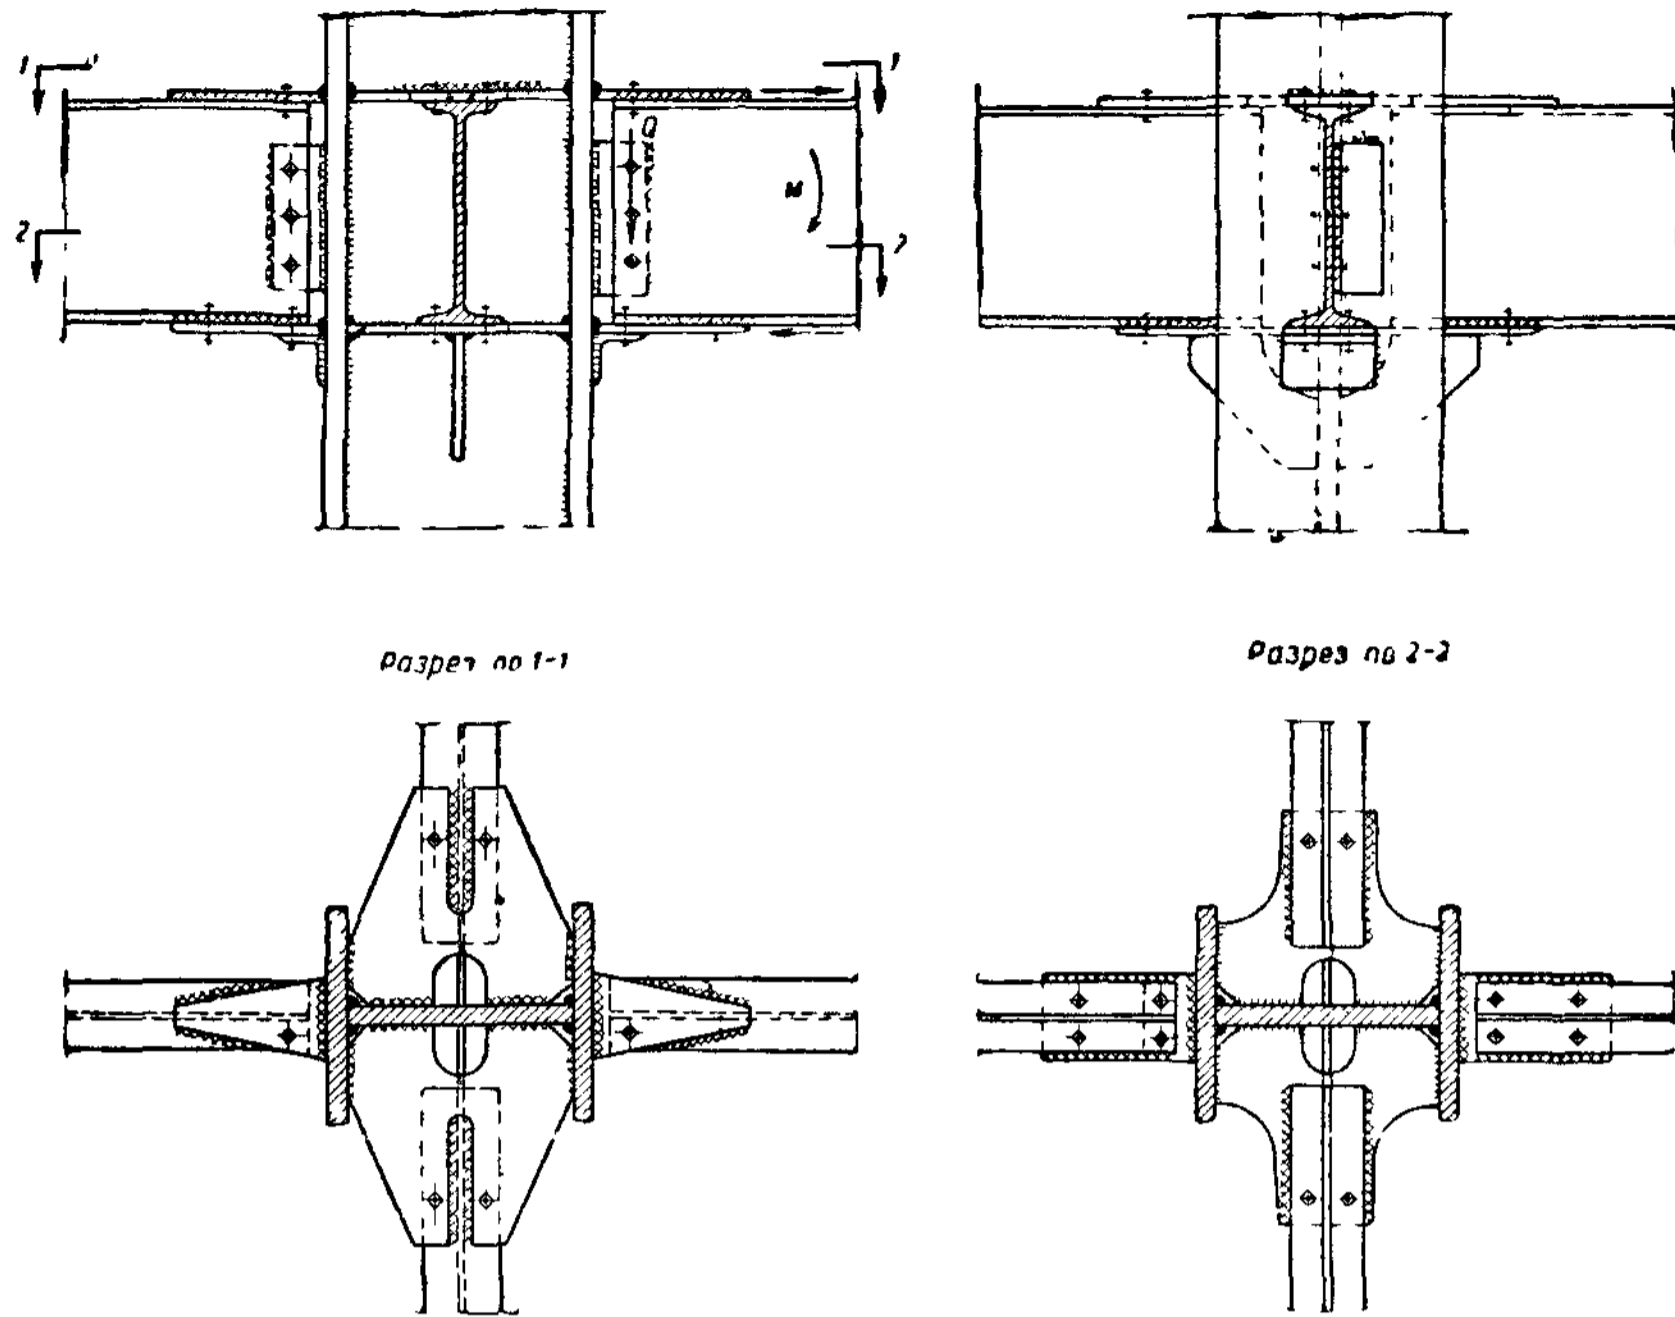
Жесткое прикрепление балок к колонне двутаврового сечения
